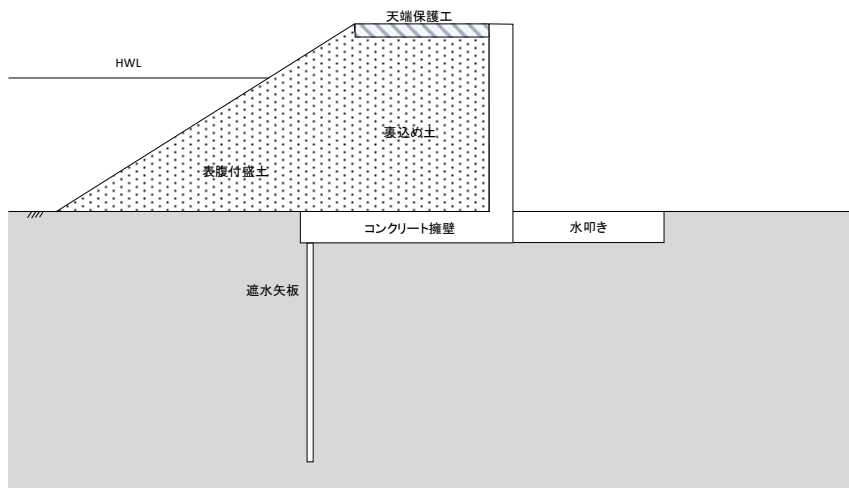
コンクリート擁壁の代表的な構造（逆 L 型直接基礎形式）
